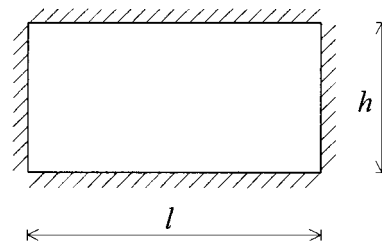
Mur maintenu latéralement en tête et en pied et sur deux rives verticales
